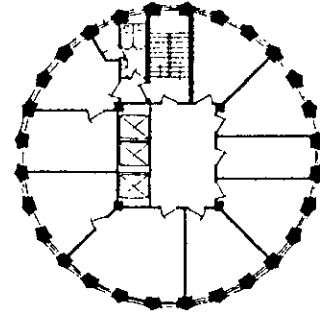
Adolf Loos: Chicago Tribune Tower Competition, 1922 Planta.
